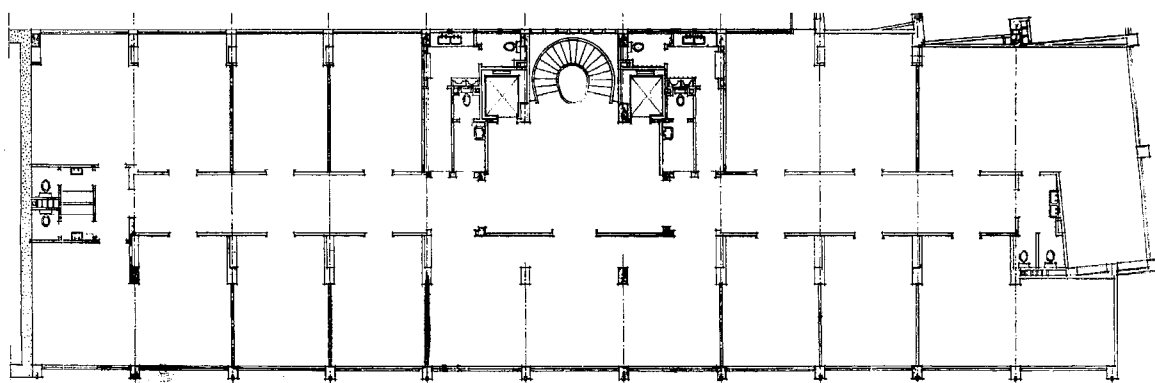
Planta de arquitectura dos Pisos 2 a 4.
